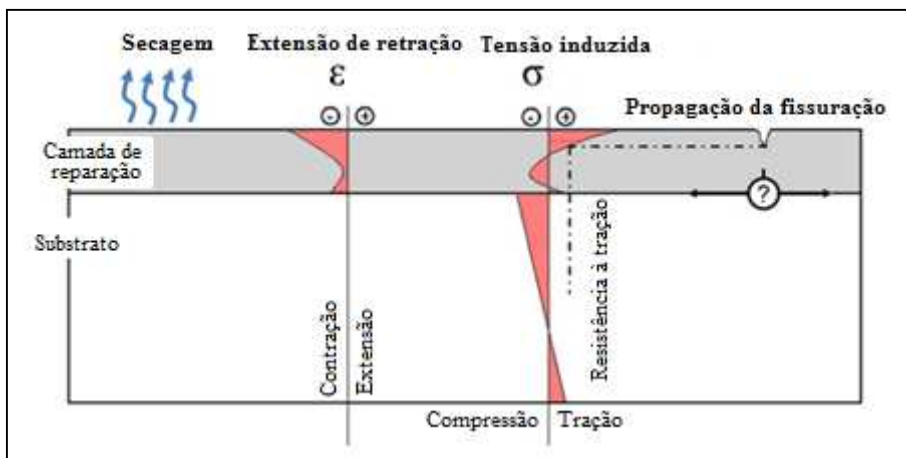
Fissuração em camadas de reparação, adotado de [136]
